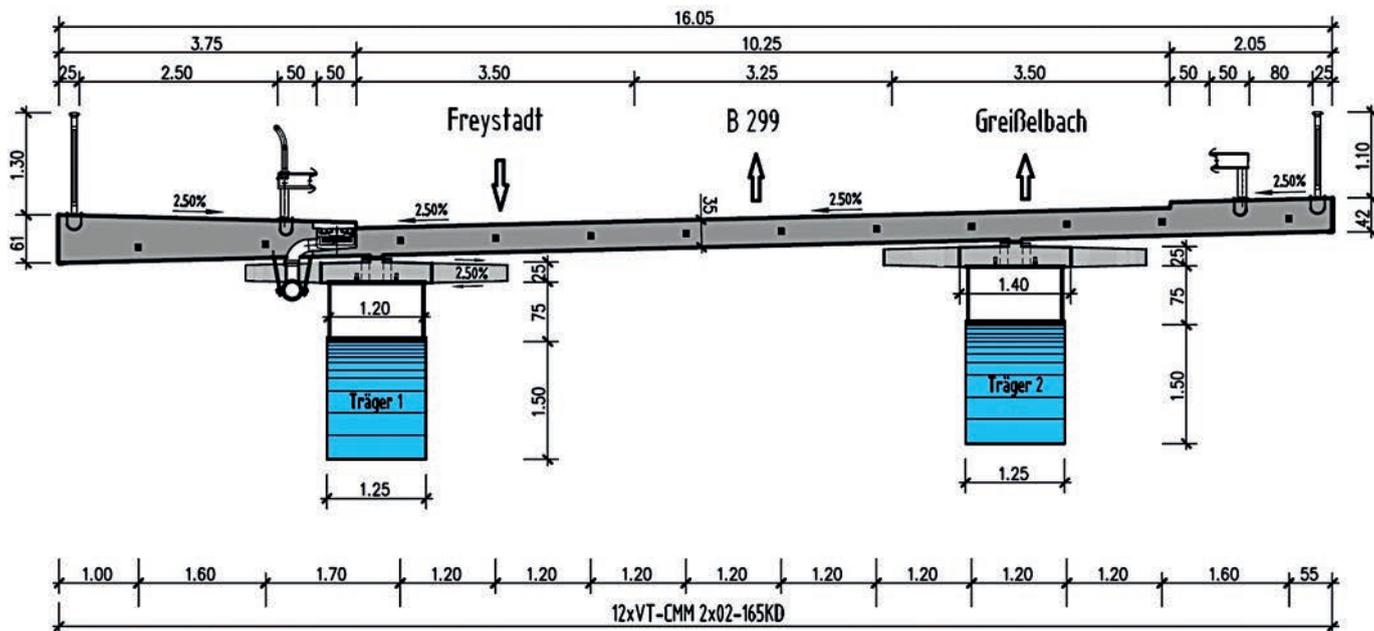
Querschnitt der Segmentbrücke Greißelbach (SSF Ingenieure)
